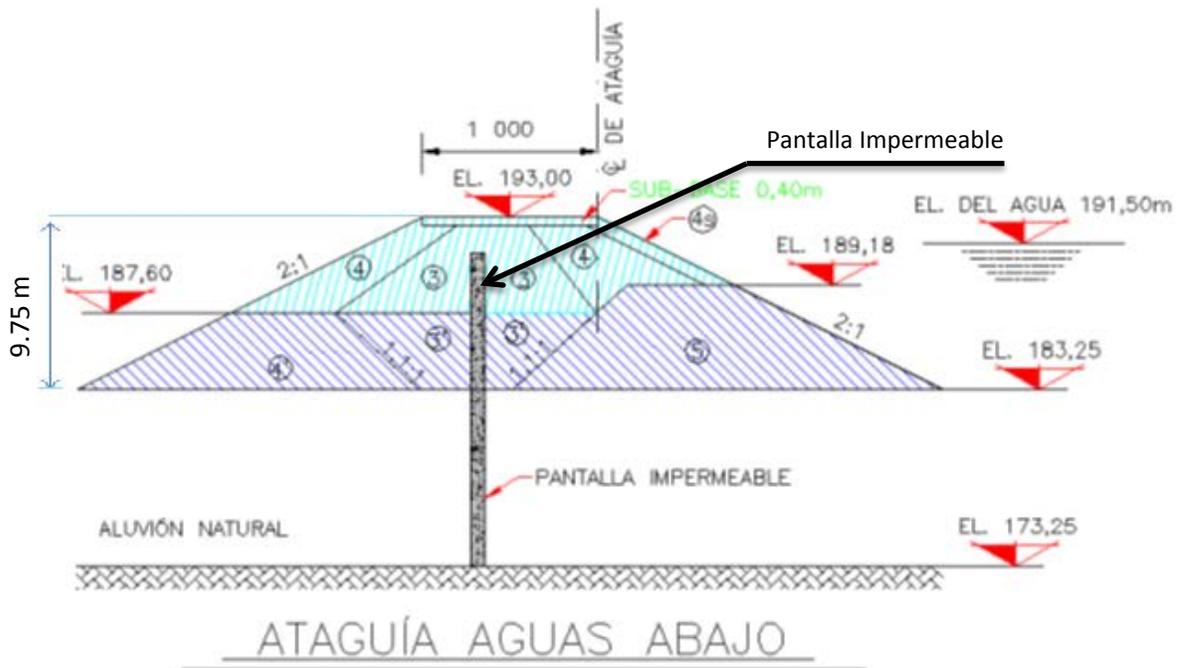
Pantalla Impermeable Ataguía Aguas Abajo corte de perfil
